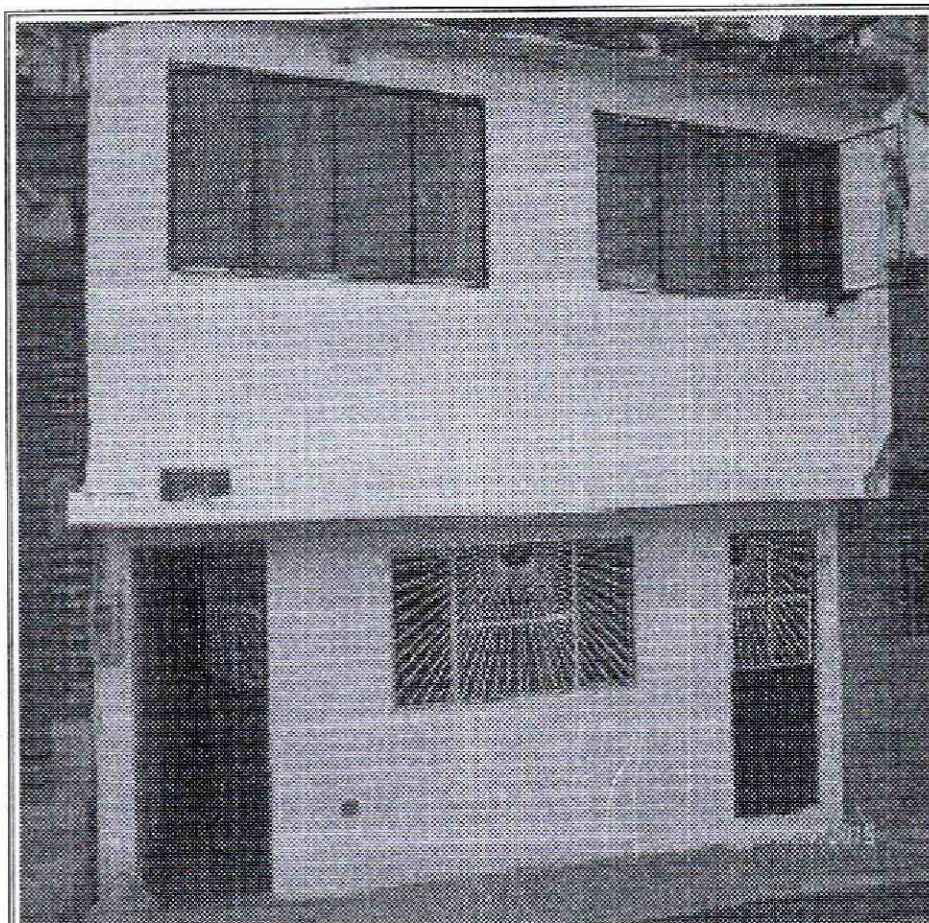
Vista frontal del predio de la Calle 1 Bis A No. 1 - 57 Este
